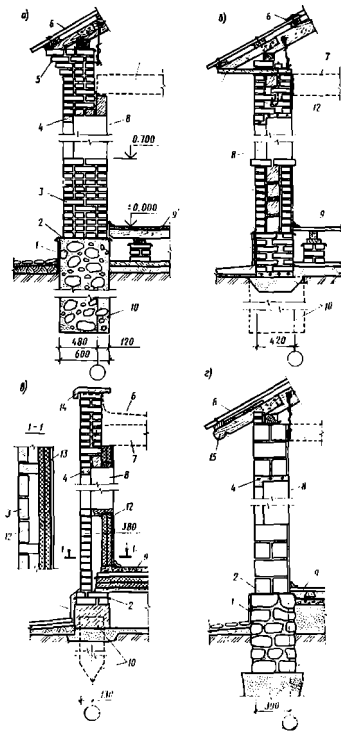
Варианты решения наружных стен одноэтажных жилых зданий из искусственных камней ручной кладки в композиции с элементами дома:
